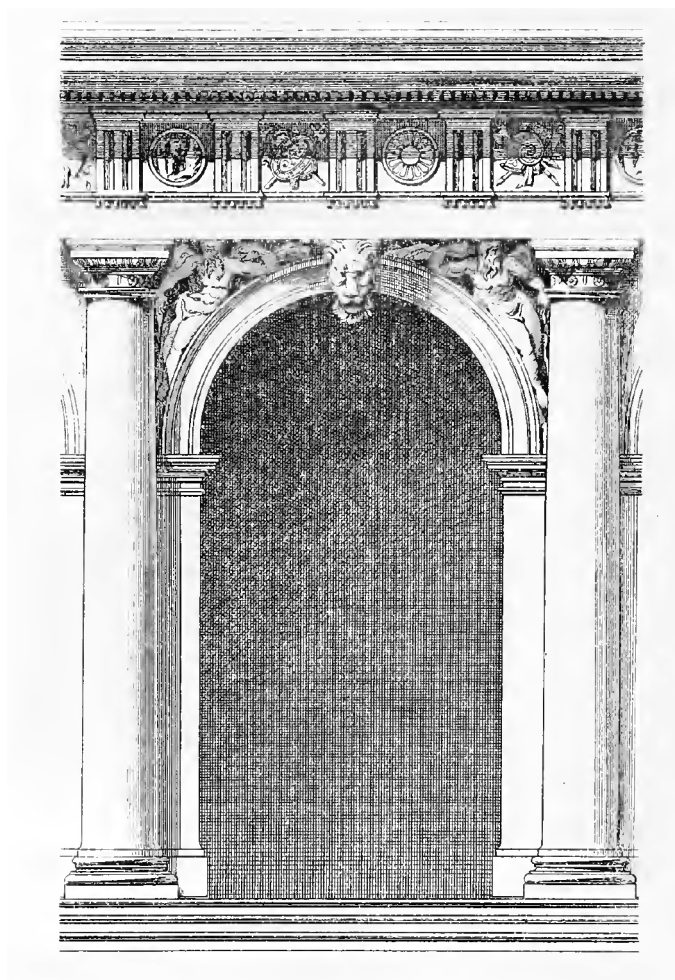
Arcade du rez-de-chaussée des nouvelles Procuraties de Venise.
